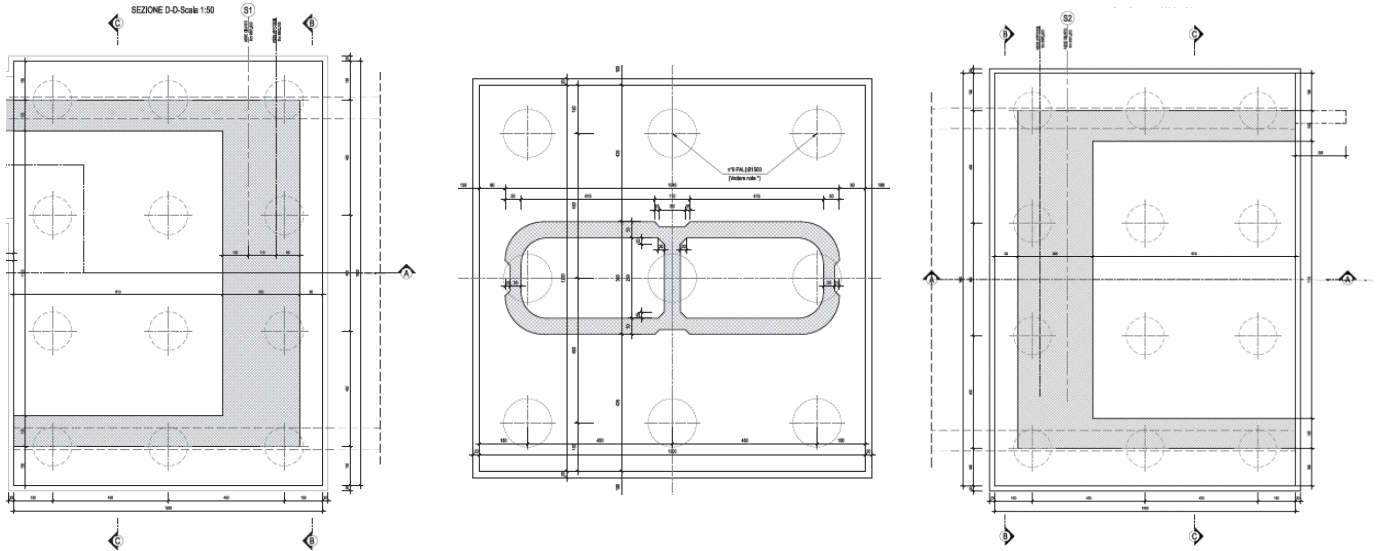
Pianta delle fondazioni delle pile e delle spalle
